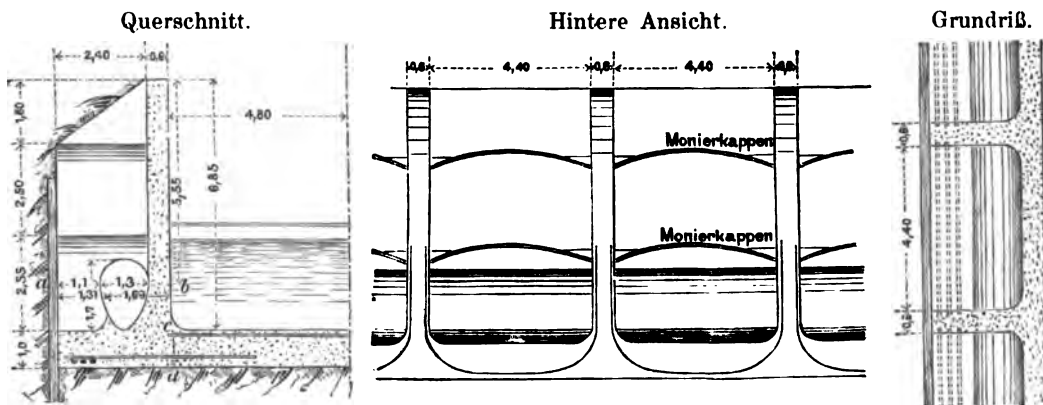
Schleuse mit Wänden und Sohle aus Eisenbeton.
